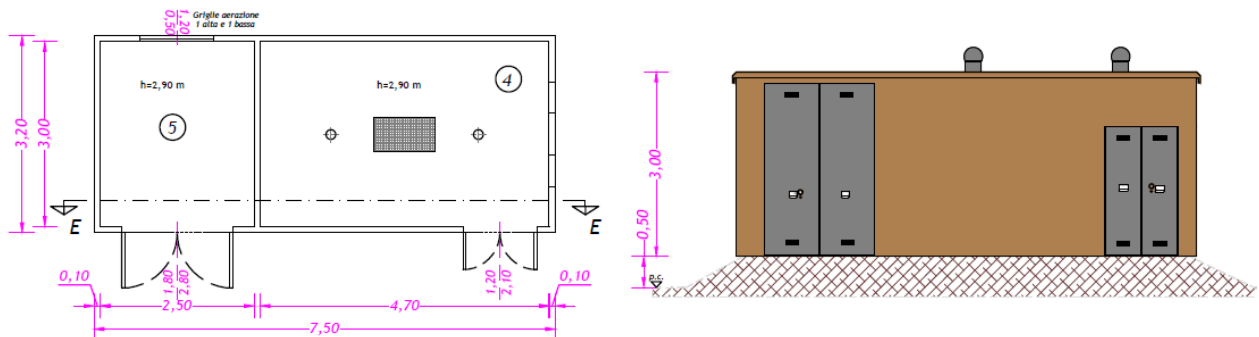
Pianta e profilo delle cabine MT/BT “2.B” e “2.C”
